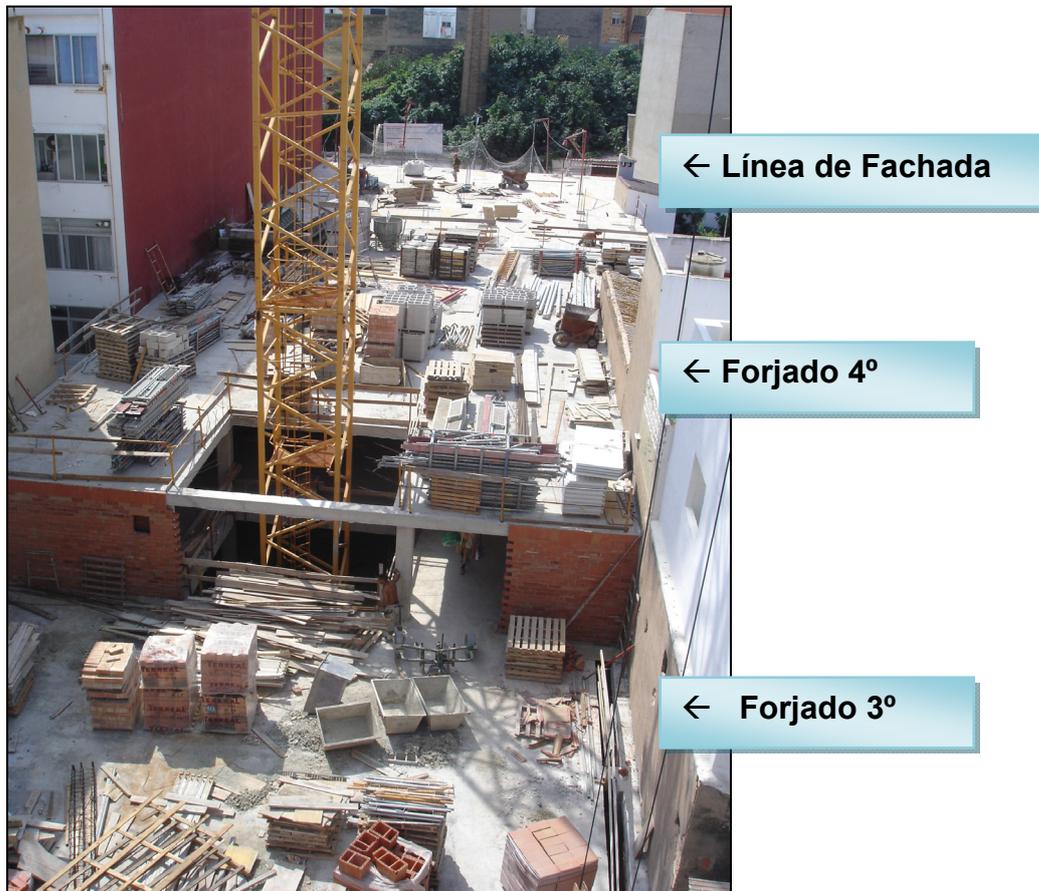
Vista de toda la estructura de fase B desde la línea de fachada hasta la fase A donde se realiza la foto.
